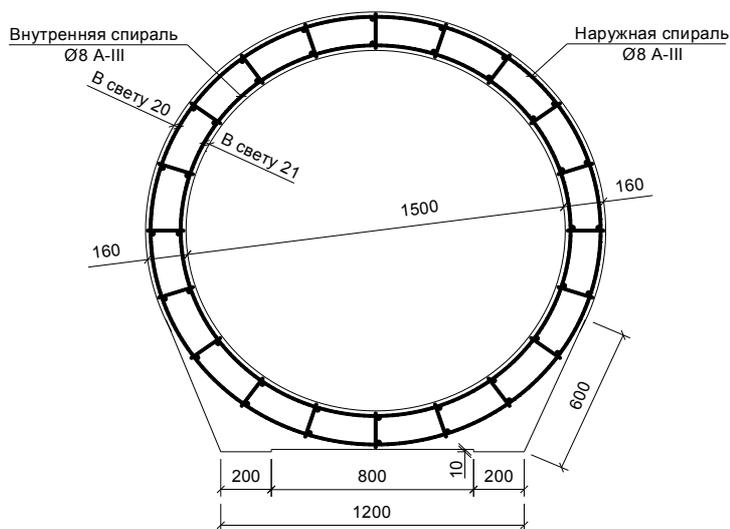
Арматурный чертеж звена трубы ЗКП6.200
